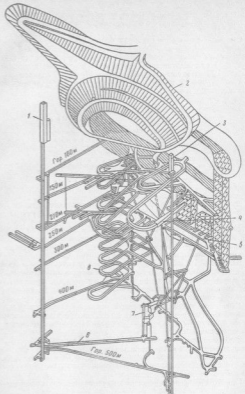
Схема вскрытия месторождения на руднике «Пюхасалми»: 1 — главный рудосборный ствол; 2 — контур карьера; 3 — вентиляционно-вентиляционный ствол; 4 — портал колодезного ствола; 5 — вентиляционно-доставочный ствол; 6 — двойной элеватор; 7 — дробильный агрегат; 8 — колодезный ствол.
